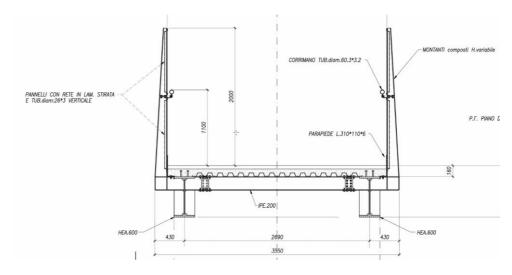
Vista della sezione trasversale della passerella sul Rio Maggiore
